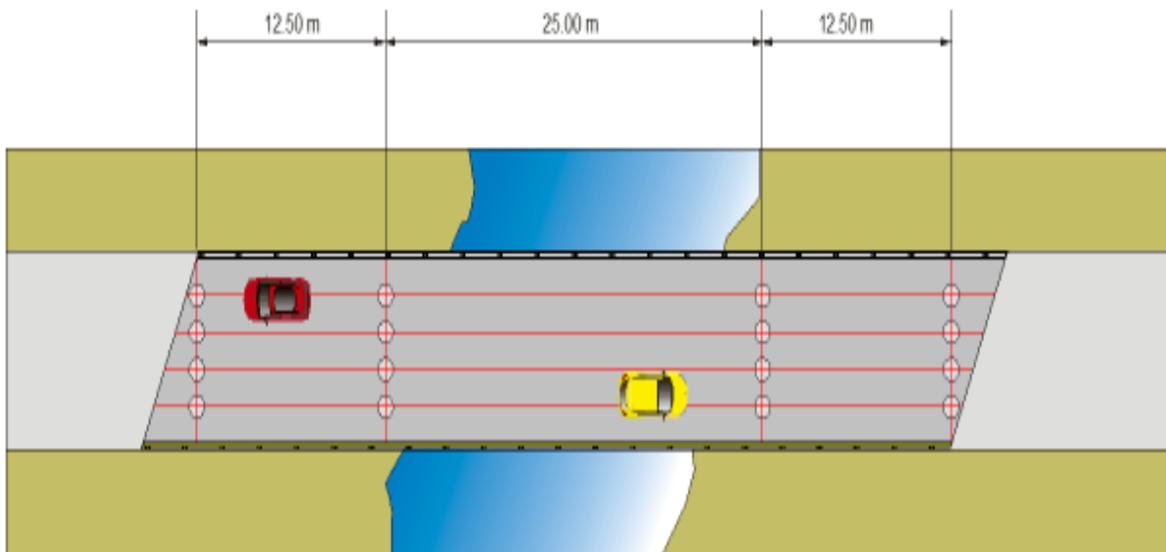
Imagen en planta. Fuente: Elaboración propia.
